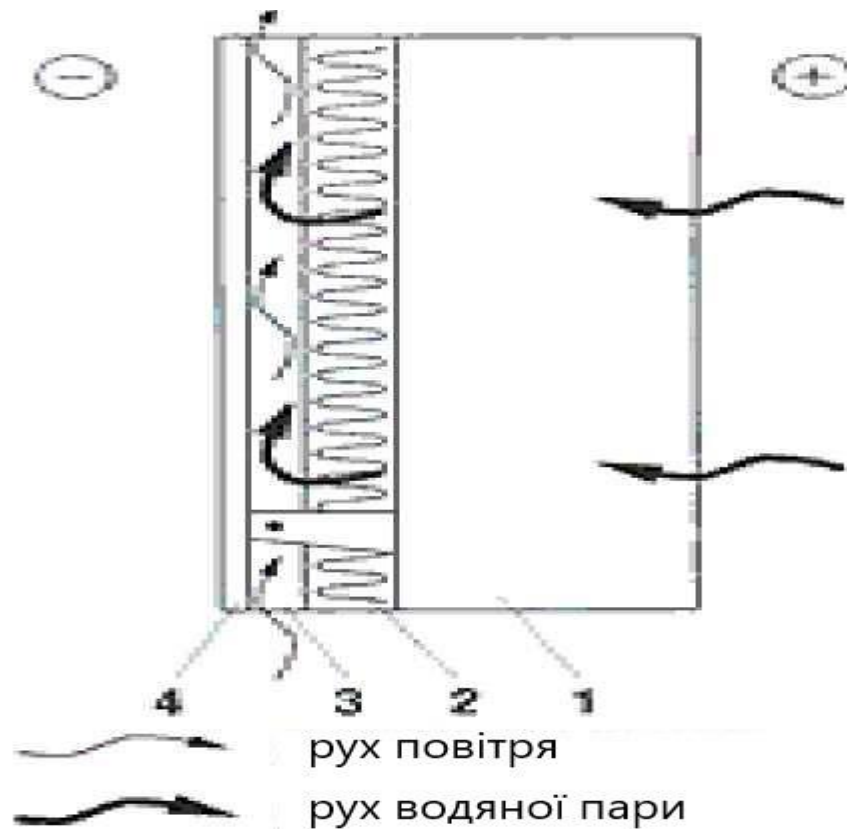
Принцип роботи вентиляваного фасаду: 1- стіна, що утеплюється; 2 – утеплювач; 3- вентиляований повітряний прошарок; 4 - зовнішнє облицювання
